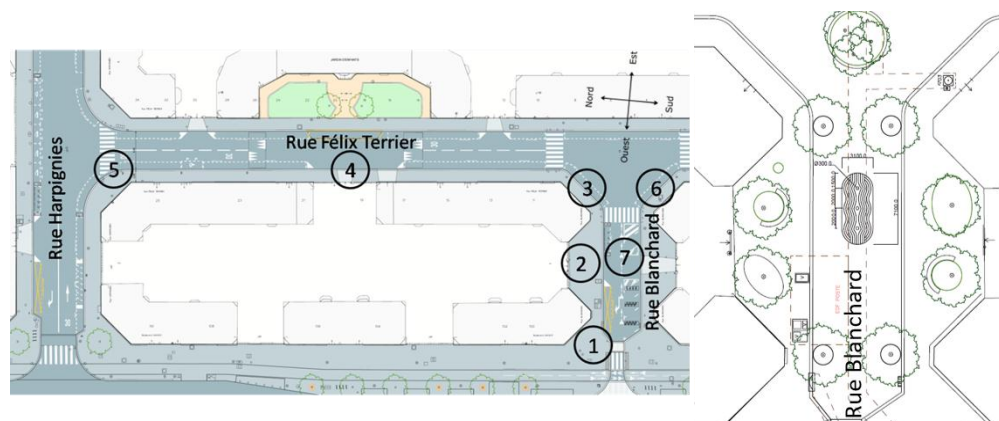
Points de mesure sur le plan travaux du site (gauche). Plan d'implantation (droite).
